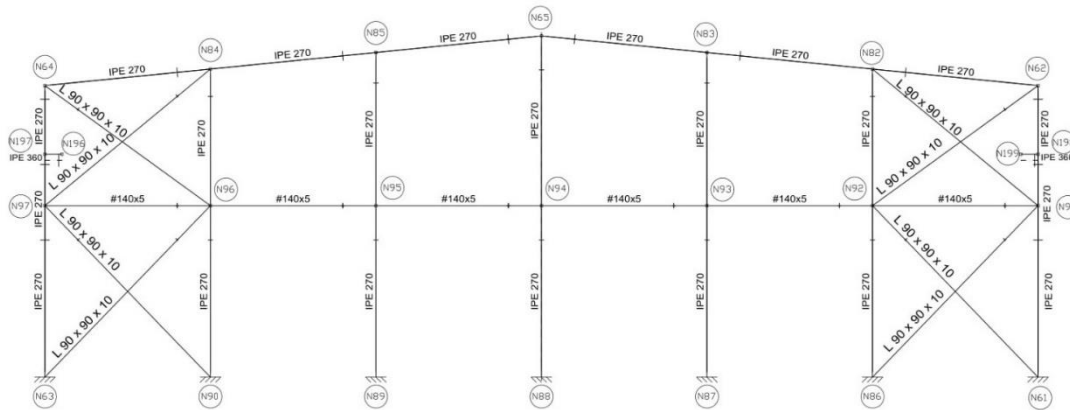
Pórtico de fachada. Fuente: Elaboración propia a partir de CYPE 3D
